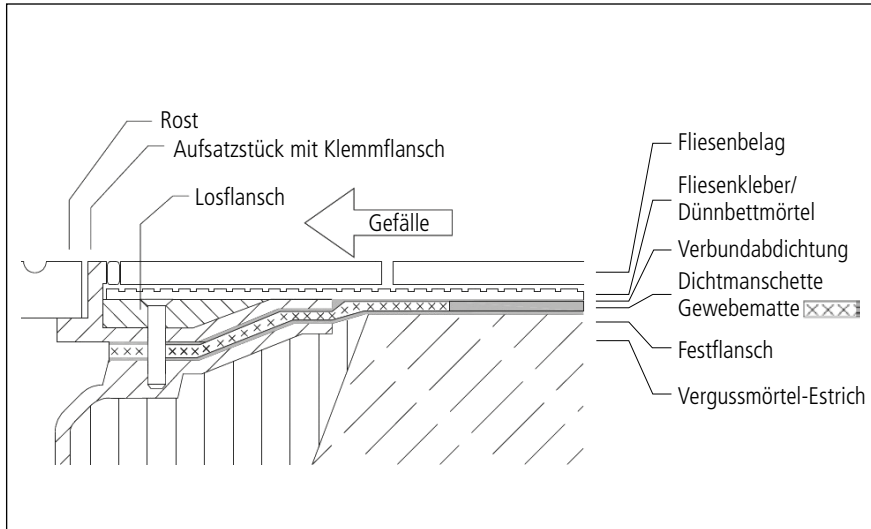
■ Anschluss eines Ablaufs an eine Verbundabdichtung mit Klemmflansch – Detail [26]
